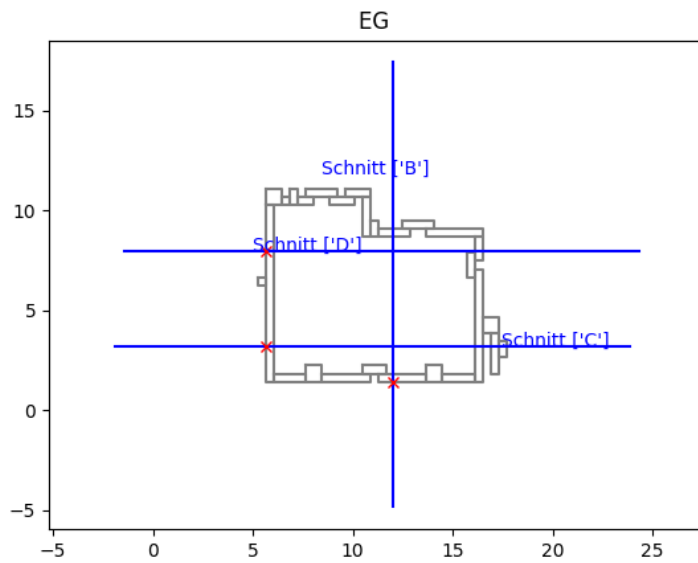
Die Positionierung von Schnitten in Grundriss (blau) und die gefundene Punkte der Gebäudegrenze (rot)
